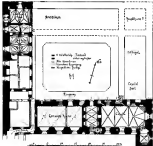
Grundriss der zwei Blätter (nach Anhang 1)
